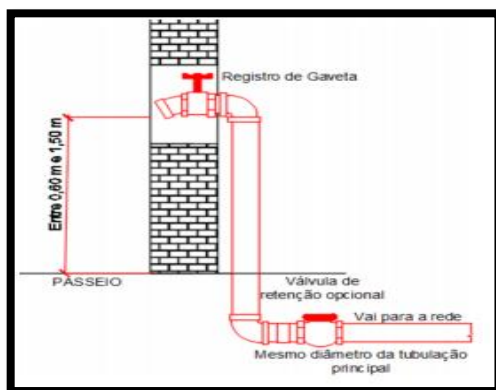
Hidrante Recalque na fachada ou muro de divisa
